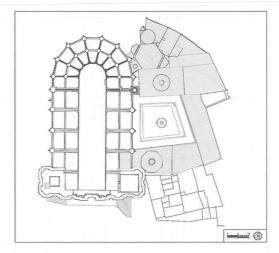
Planta Cubiertas catedral Santa María de Tortosa
